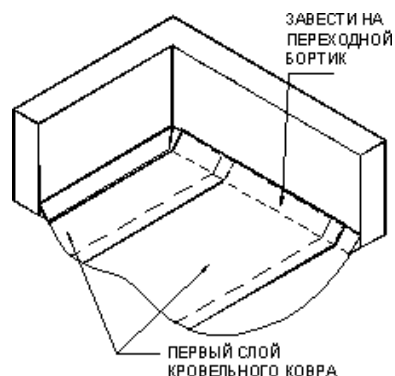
Схема устройство примыканий первого слоя кровельного ковра
